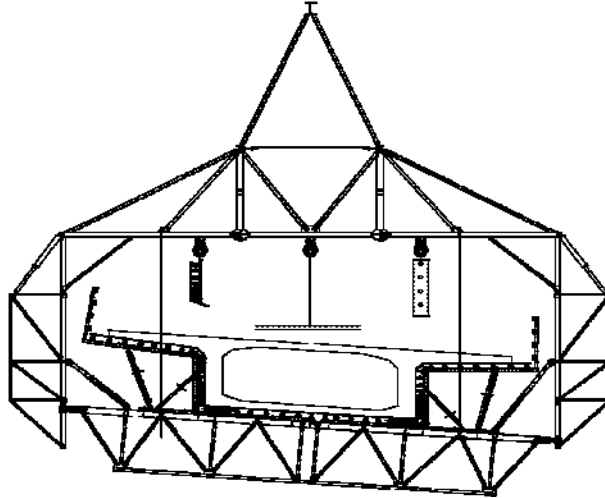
Cimbre em posição de betonagem (corte transversal)
